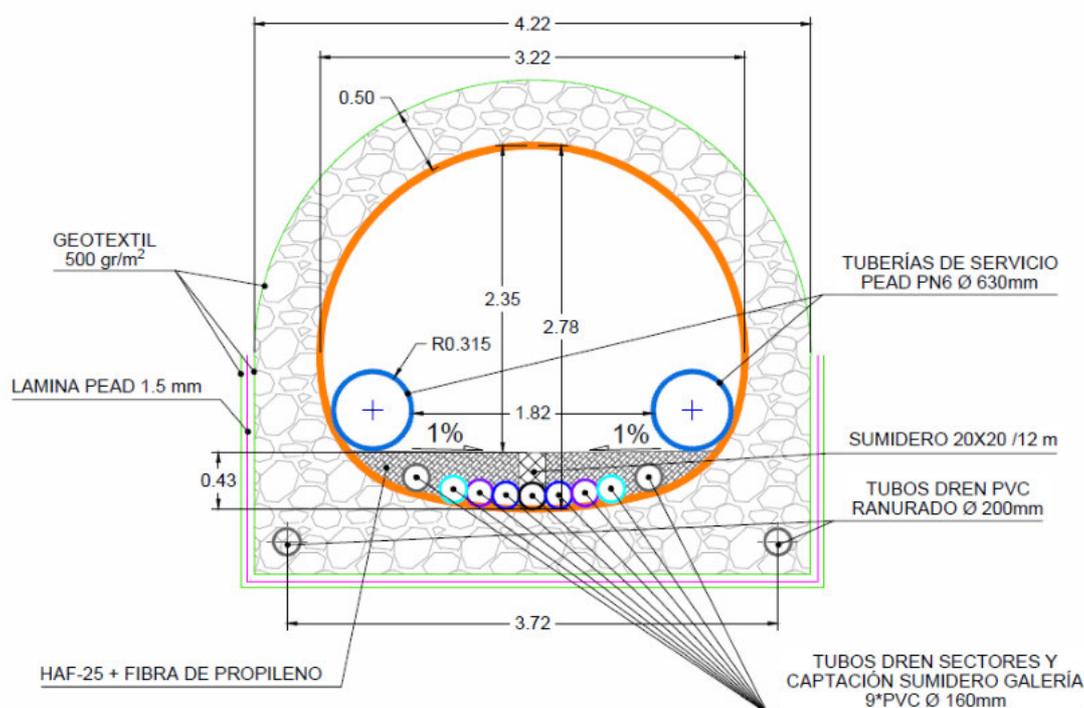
Detalle de sección de la galería Fuente: Elaboración propia
